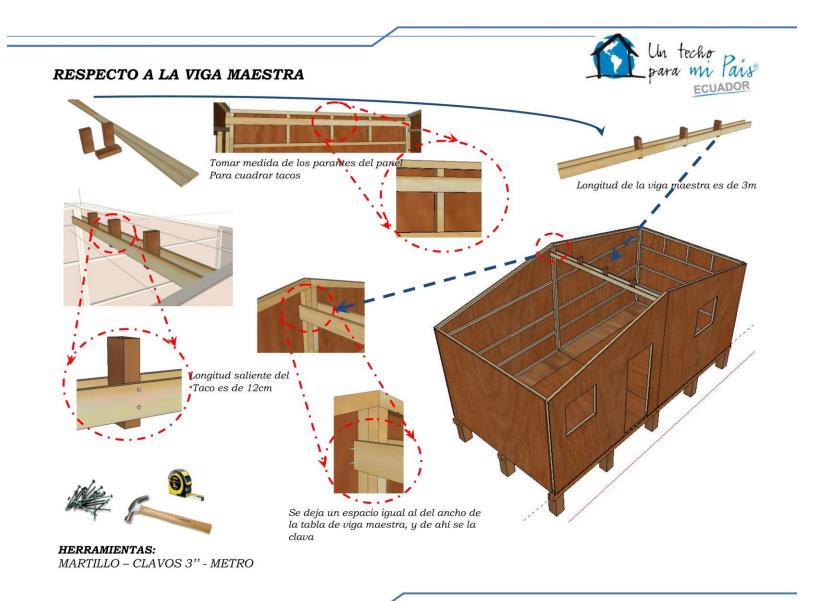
Colocación de viga maestra, Fuente: Manual para la construcción - TECHO
